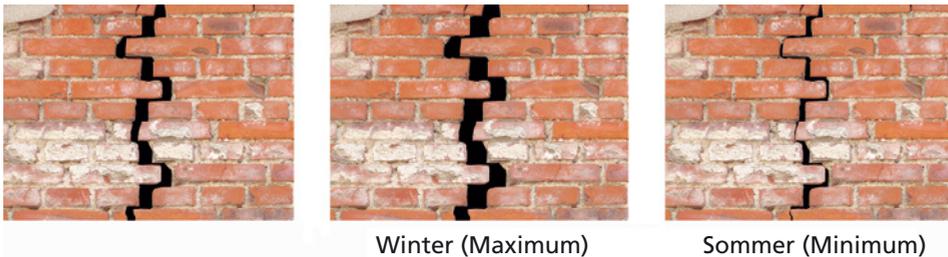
Rissbreiten bei älterem, unbehauerten Mauerwerk (Foto zur Veranschaulichung manipuliert)
